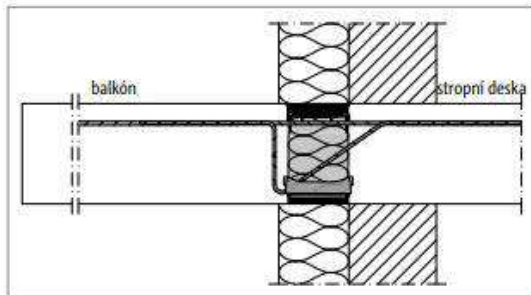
Schöck Isokorb® T typ SQP s přípojným adaptérem: Napojení na železobetonovou stropní desku; izolant uvnitř vnějšího zateplení
